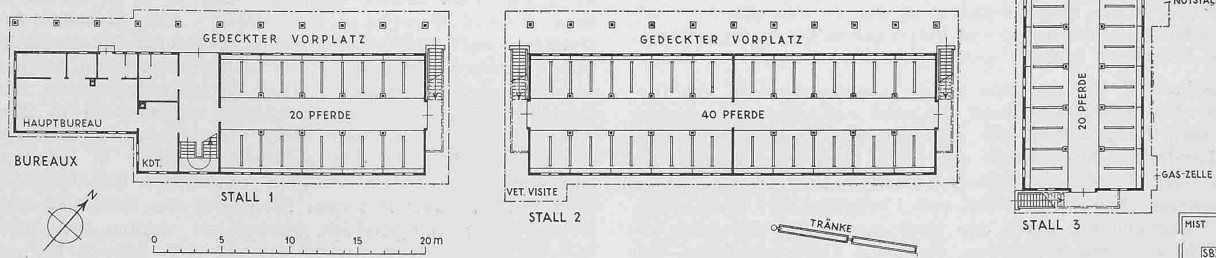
Grundriss 1:500 einer militärischen Pferdekuranstalt, Ställe 1, 2 und 3
